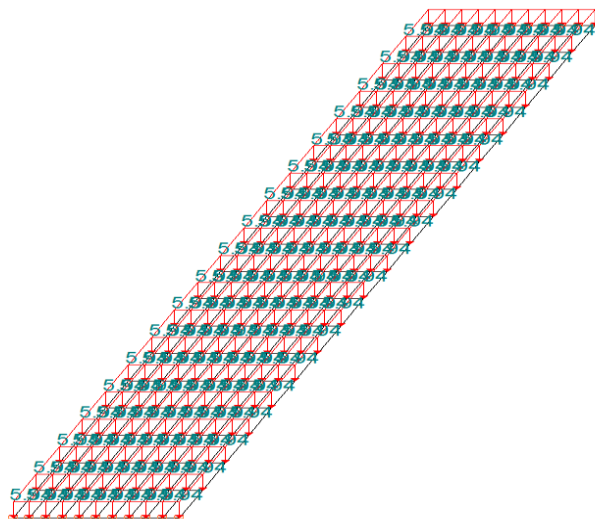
Загружение схемы нагрузкой от собственного веса
